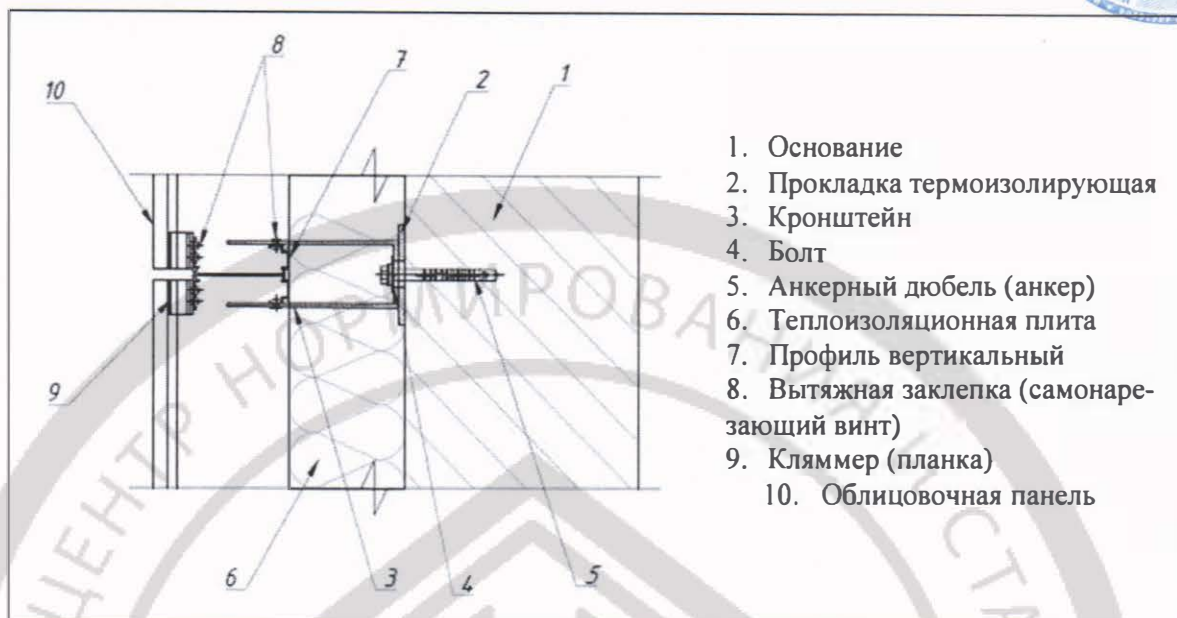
Горизонтальный разрез фасадной системы «МТС-v-350» (второй вариант конструктивного исполнения несущего каркаса)
